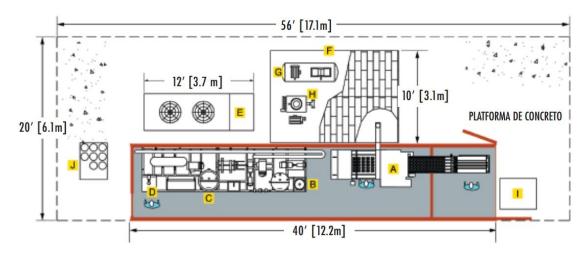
Planta en contenedor. Breaker in a box
